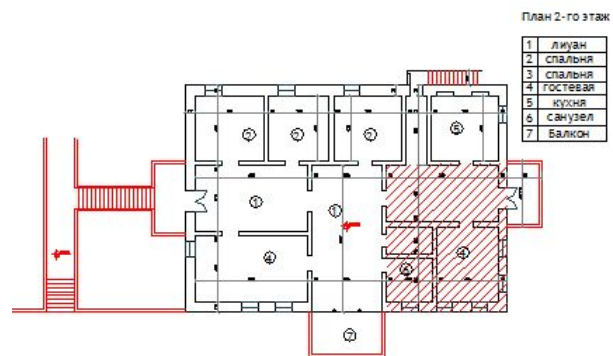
Проект реконструкции жилого дома 1905 г. строительства в г. Адайси. План 2-го этажа. Проект. Арх. Бошар Мохсен
